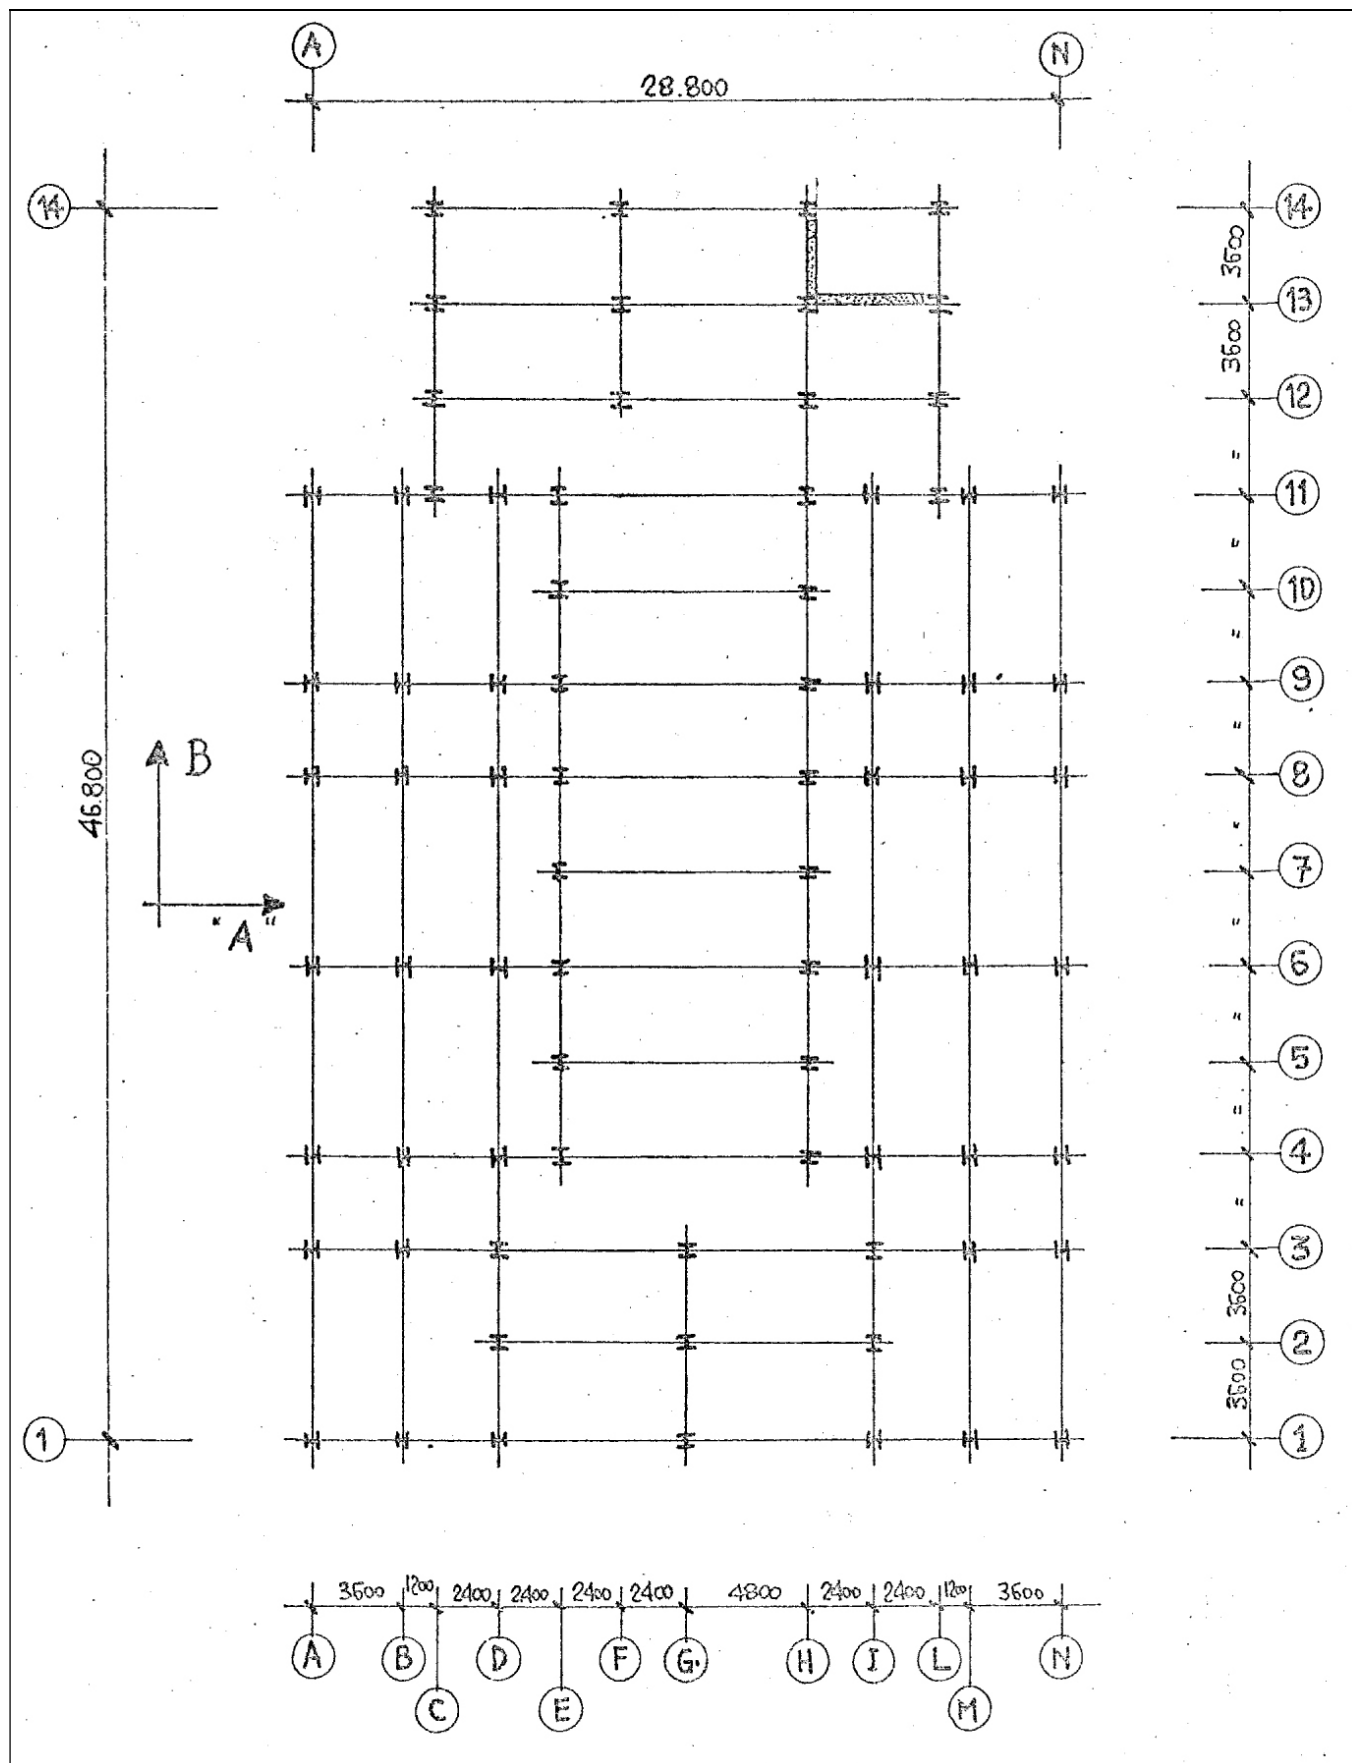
Estratto del progetto originale: planimetria strutture verticali.
